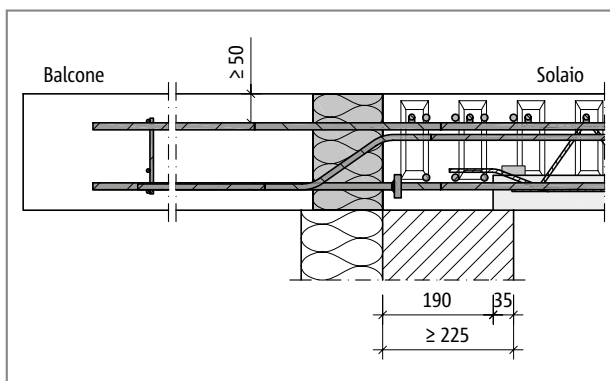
Schöck Isokorb® tipo EXT: soletta dell'elemento senza supporto sul bordo con cappotto (sezione EXT-R-CV50; vista EXT-L-CV35)
